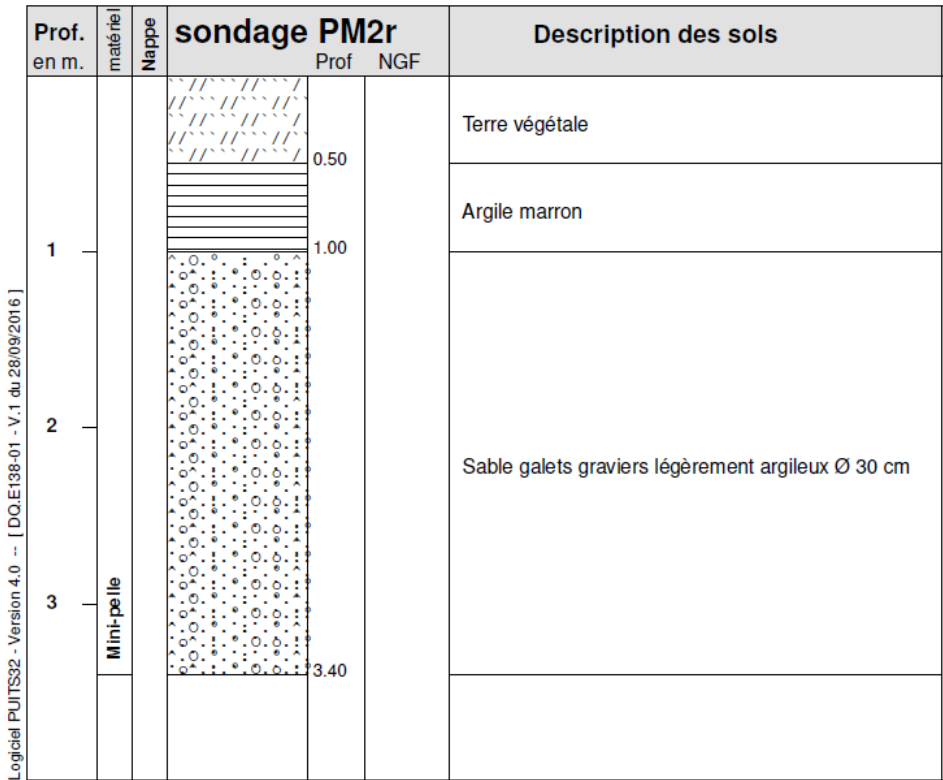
Coupe du sondage PM2r (Source : Etude géotechnique Ginger, Février 2020)
